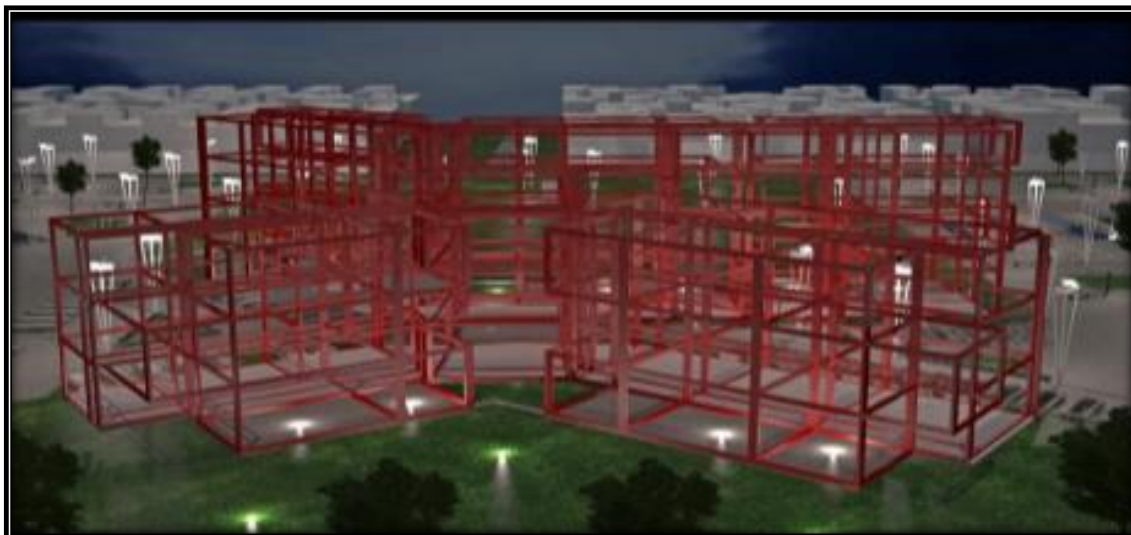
Esquema estructural de columnas y vigas IP metálicas
